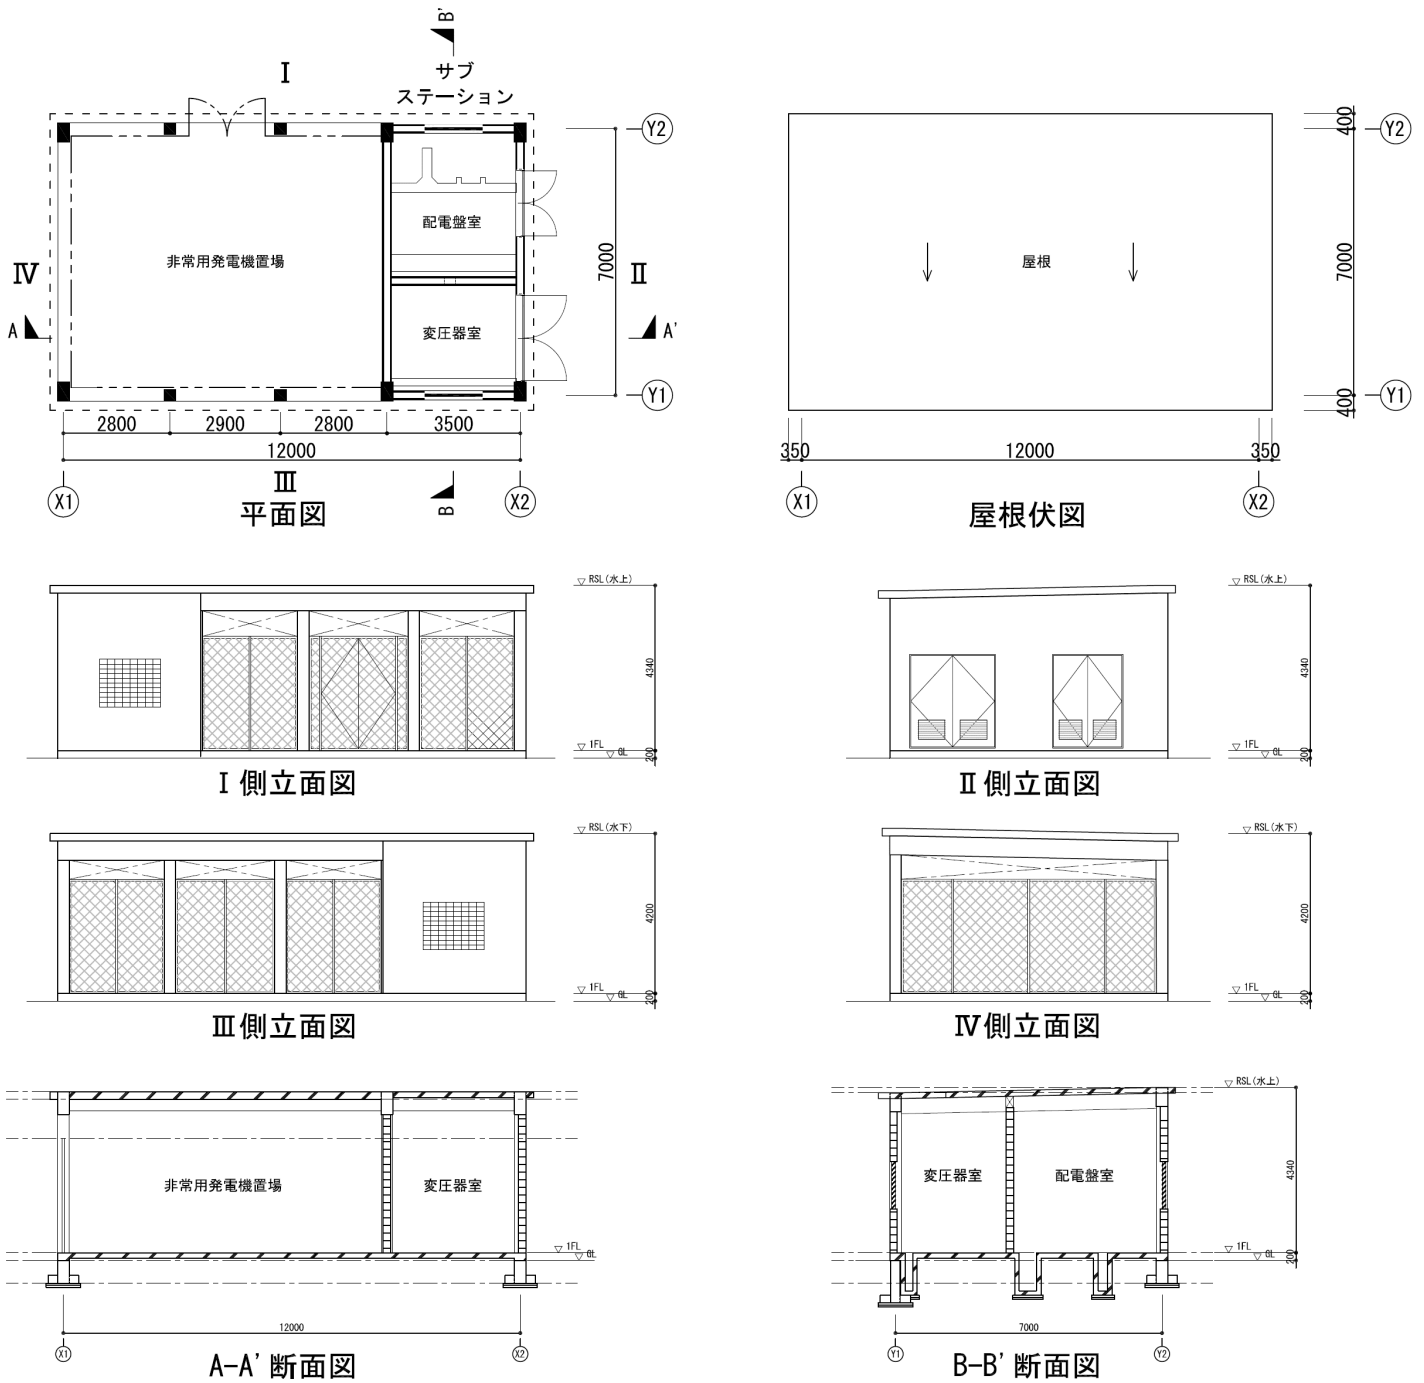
： ムシリー次レベル病院 附属棟(電気室) 平面図・立面図・断面図 1/200
